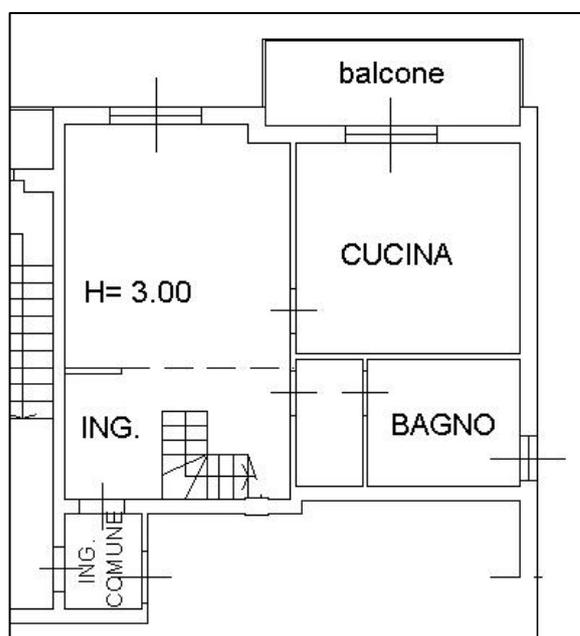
Planimetria catastale 31.12.2009 - Piano.2°
